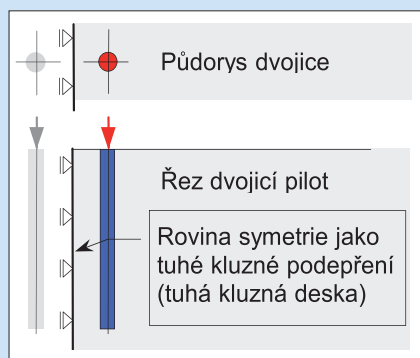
Schema zatěžovací zkoušky stavby na velkoprofilových vrtných pilotách
